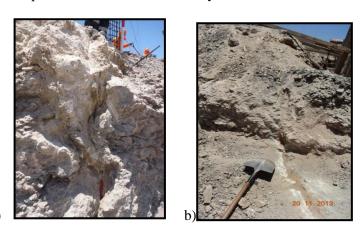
a Fracturamiento Principal identificado en la excavación, Foto 2.b presencia de caliche cementado y arena rojiza suelta rellenando el fracturamiento principal
